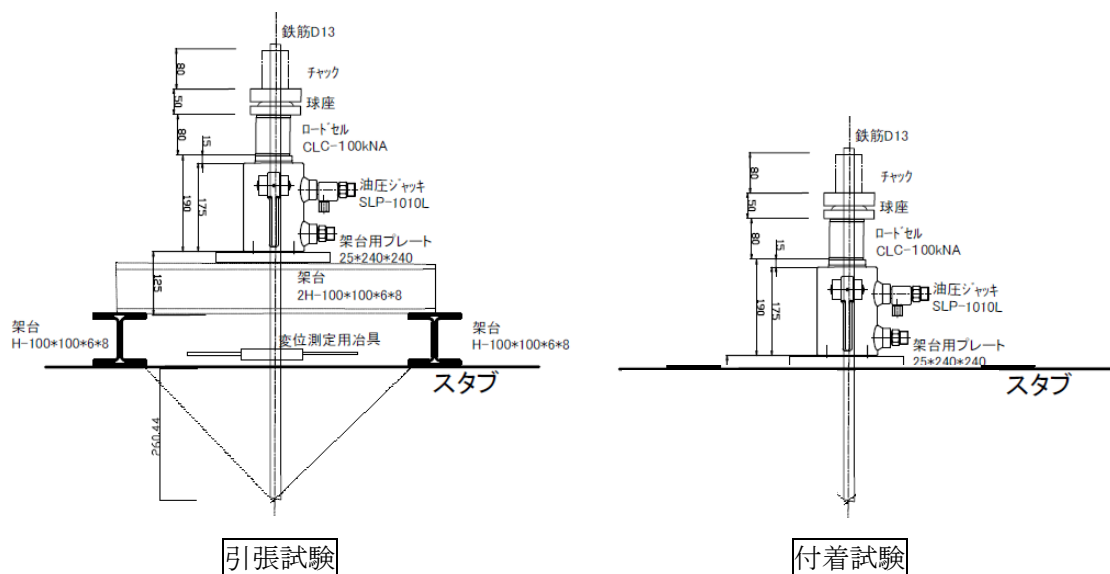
あと施工アンカー単体引張実験荷重装置図
